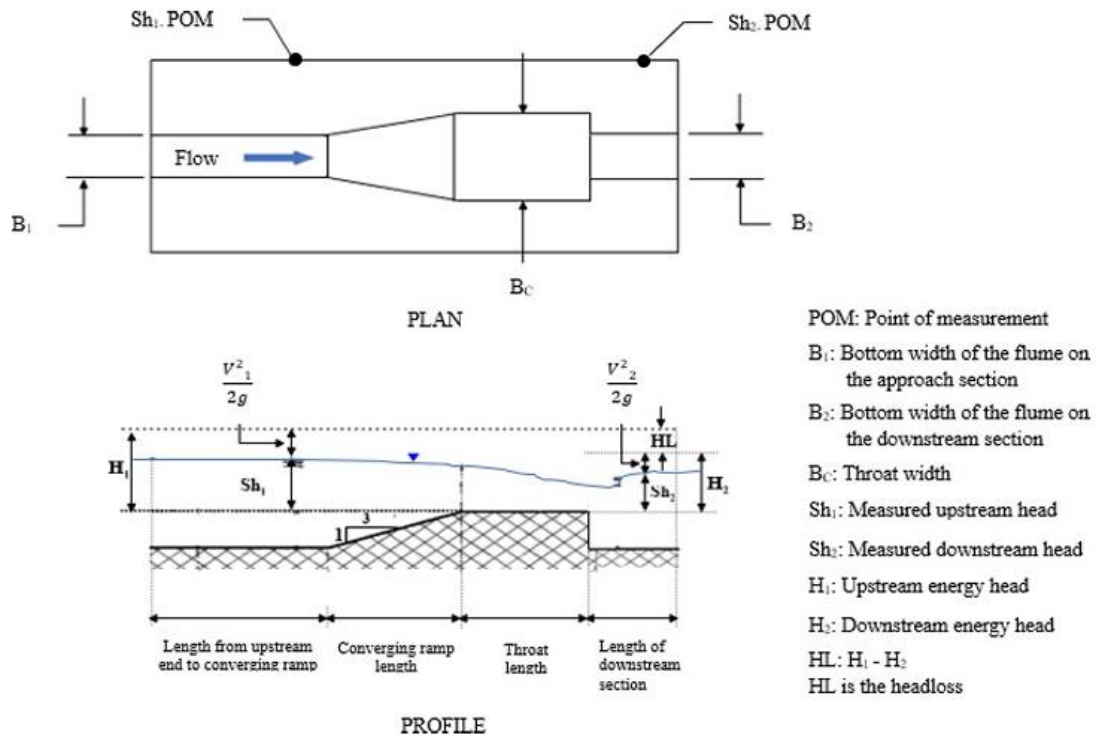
Vista en planta y perfil canal RBC (Clemmens et al., 2001)
